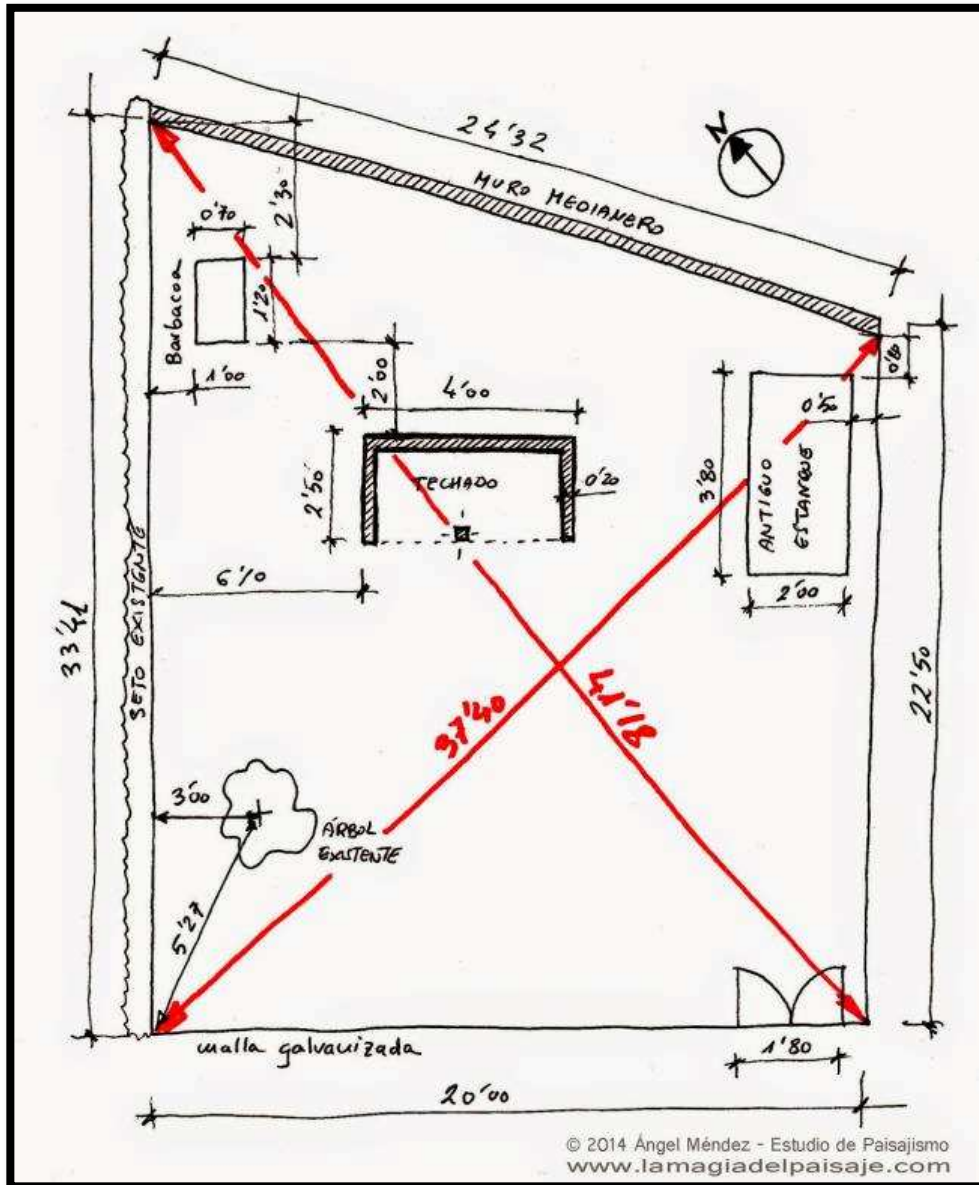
Croquis de un levantamiento a mano alzada. Fuente: Méndez, 2014.
